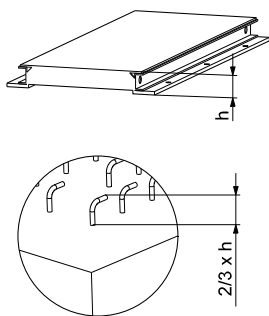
Усиливающие стальные стержни, устанавливаемые в фундамент
